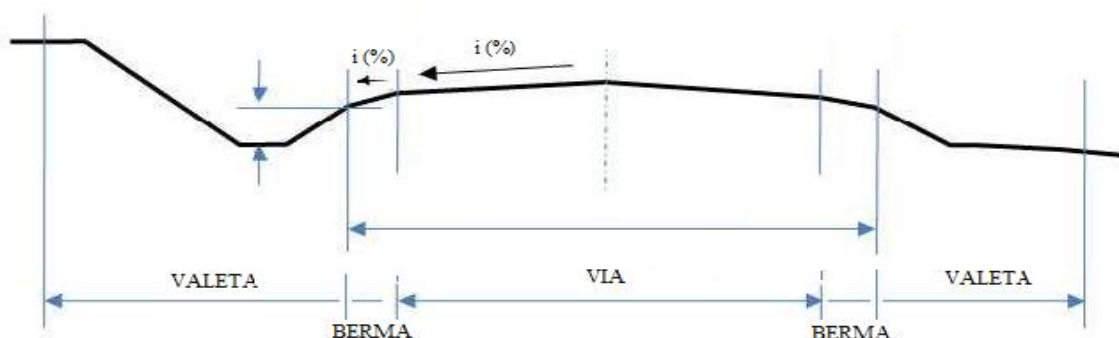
Perfil transversal de uma estrada não pavimentada (Santos, 2013).
